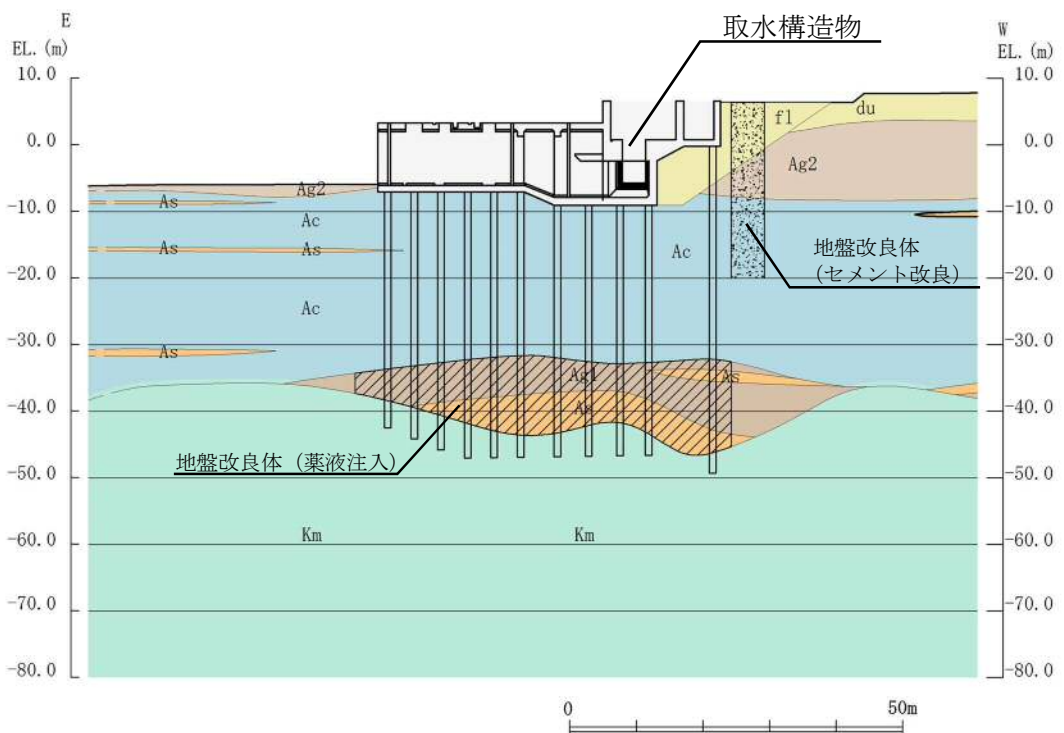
(3) 地質断面図 (⑥-⑥断面)
